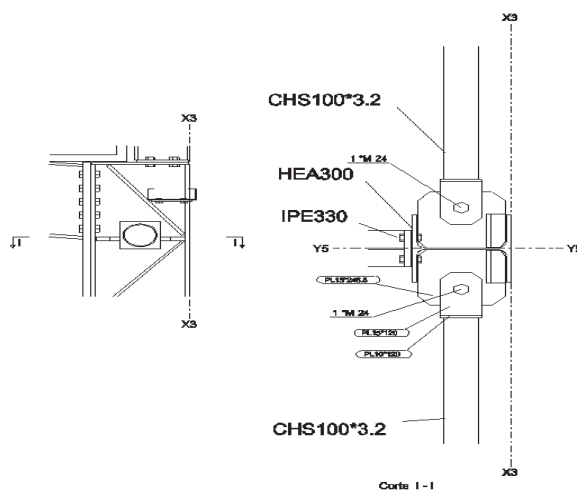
Proposta de alteração da ligação de contraventamento entre pórticos.
